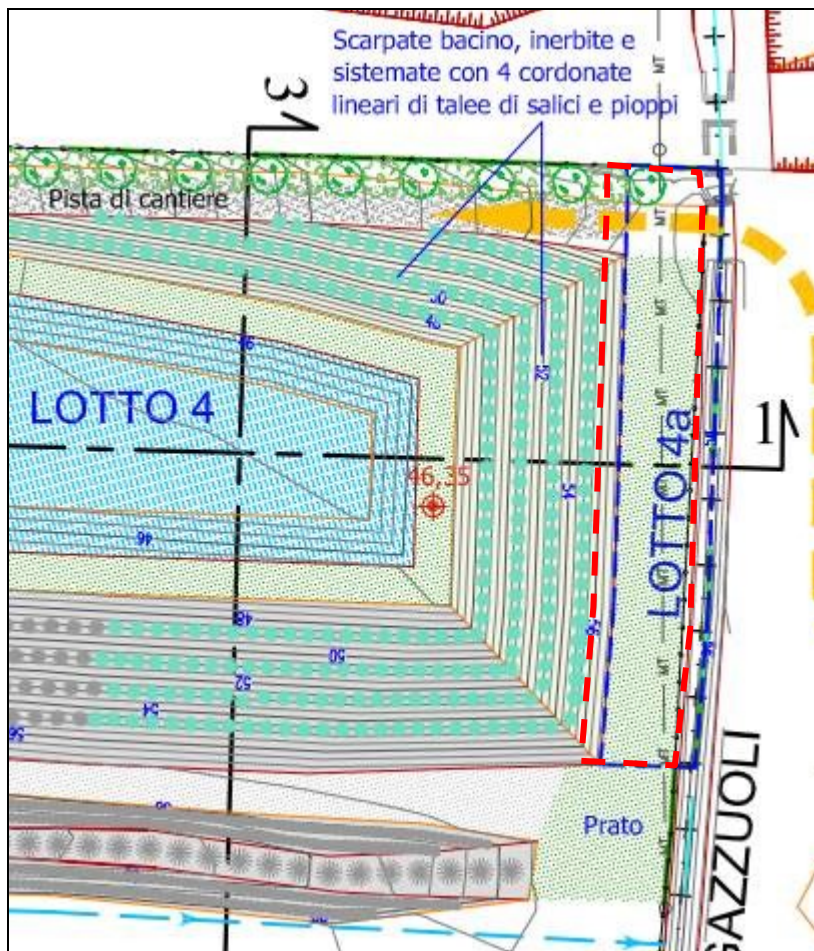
Cava Gazzuoli-FO - stralcio della planimetria di sistemazione autorizzata (aut. 15393/2014 del 15/07/2014) - settore Lotti 4-4a.
